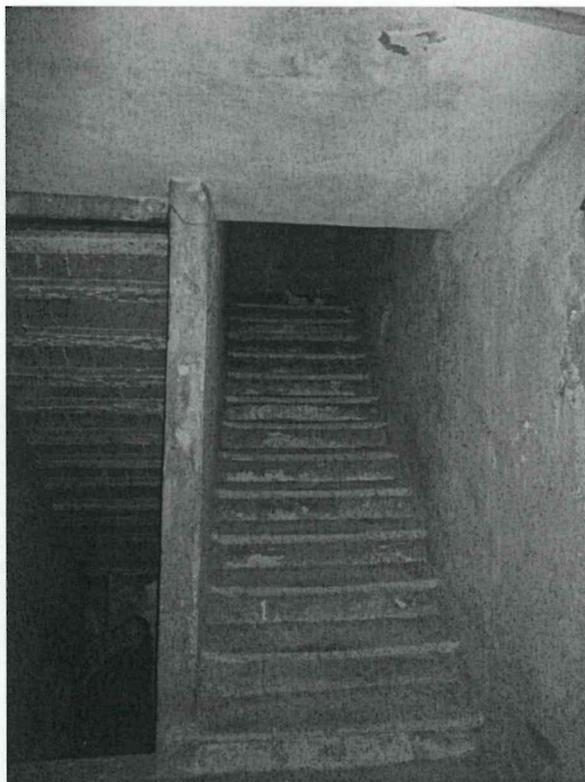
Vano scala che conduce a soffitte (Civ.17) – P. Ammezzato/1° Piano
